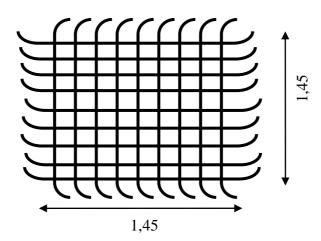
Vue en plan d'un croqué de ferraillage de la semelle
